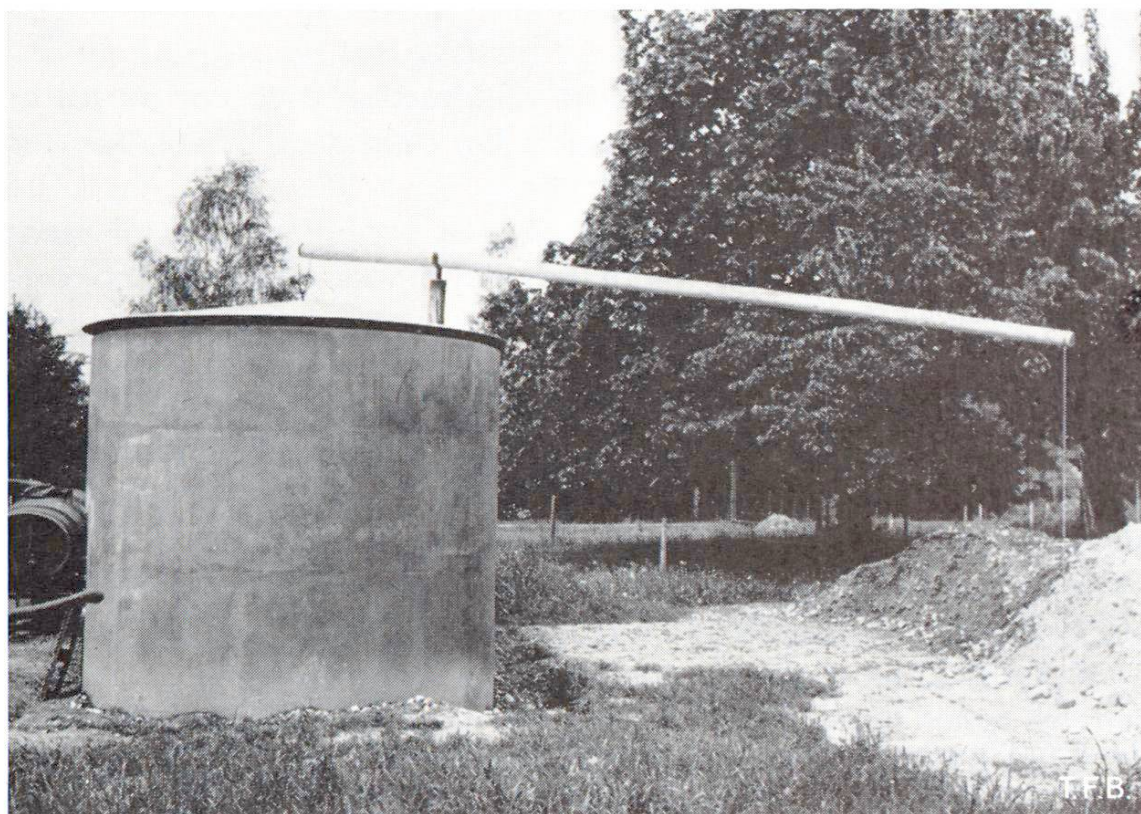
Silo en élévation avec toiture munie d'un dispositif d'étanchéité
